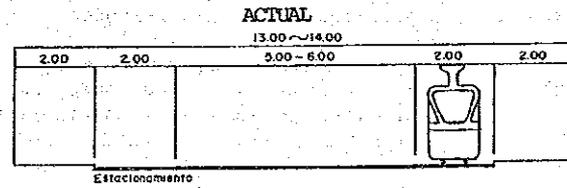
(3) · SECCION TRANSVERSAL
